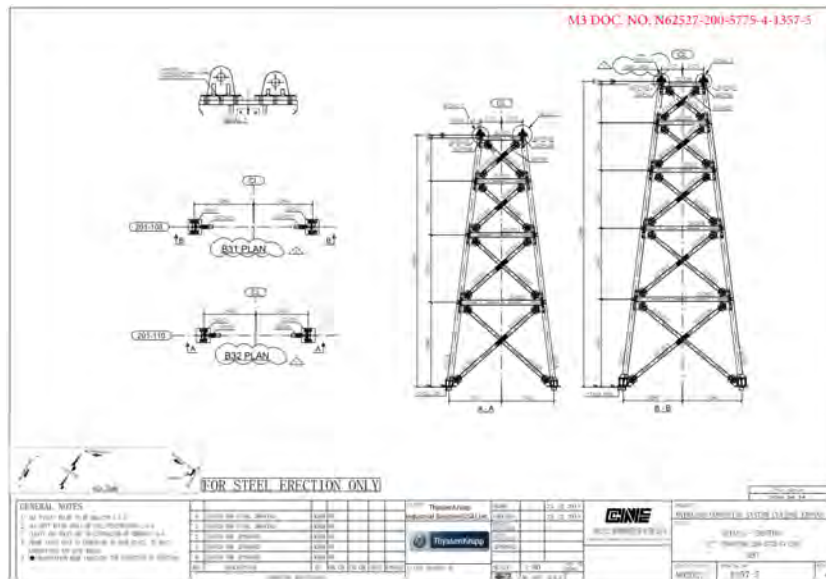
3 Plano de Construcción Bent 31, 32, donde se indica el nivel de la placa base de la estructura – Tyssenkrupp
